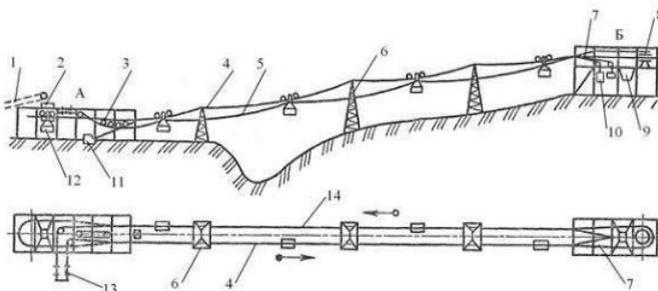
Схема конструкции двухканатной грузовой подвесной дороги:
